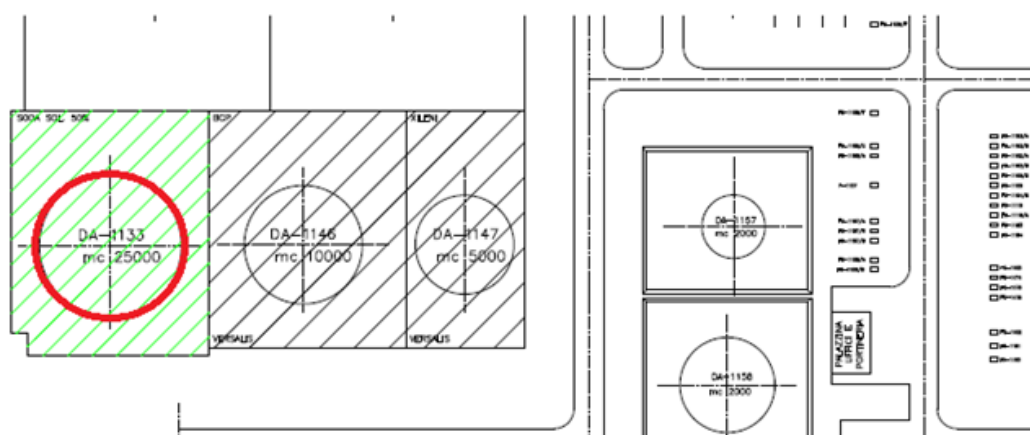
Stralcio planimetrico del serbatoio DA-1133 in area SG11
